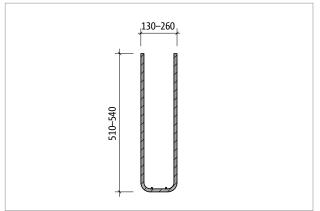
Schöck Sconnex® Typ W Part TB: Zulagebewehrung 3 \varnothing 12/65 mm; Bügel als Spaltzugbewehrung
